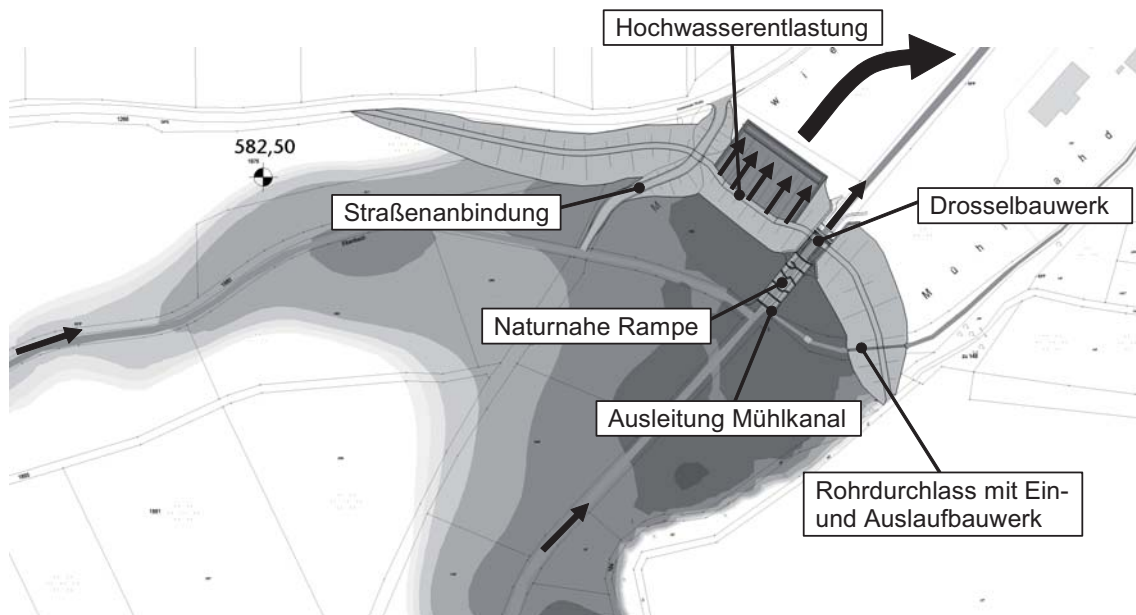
Lageplan Damm – Hochwasserrückhaltebecken Oberrieden.
